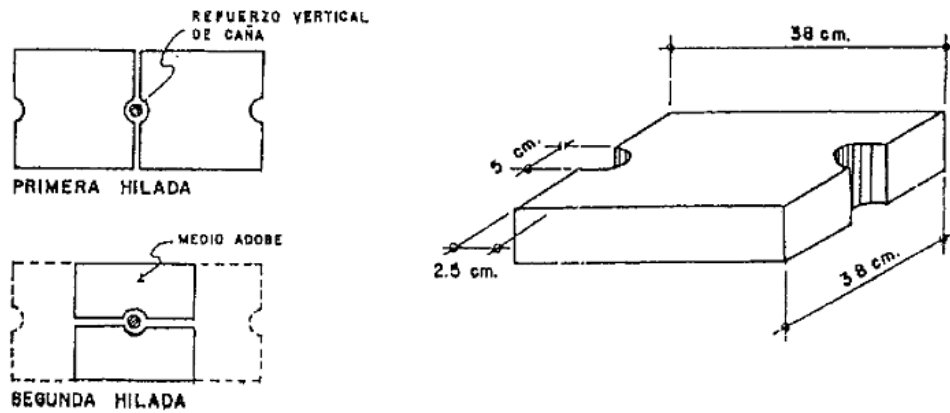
Refuerzos verticales y detalle de alveolos en adobes.
